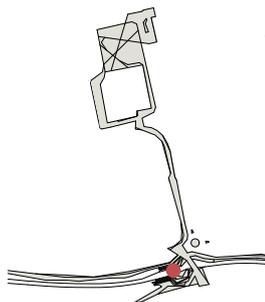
Plan Stadteingang und Donau-Radweg, M: 1:2000
